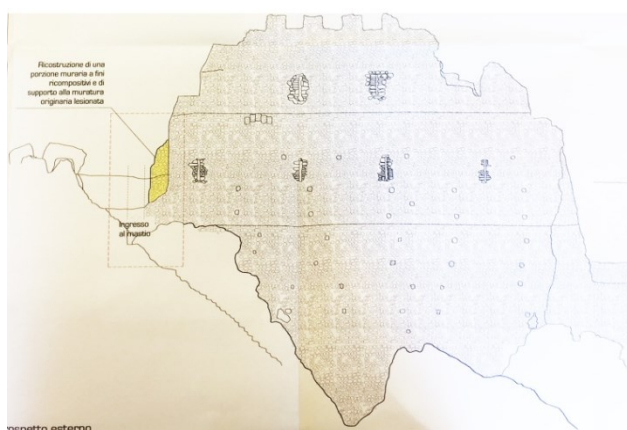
Progetto per il consolidamento nel prospetto Ovest di Acquafredda (ASBEAP_CA-OR)
